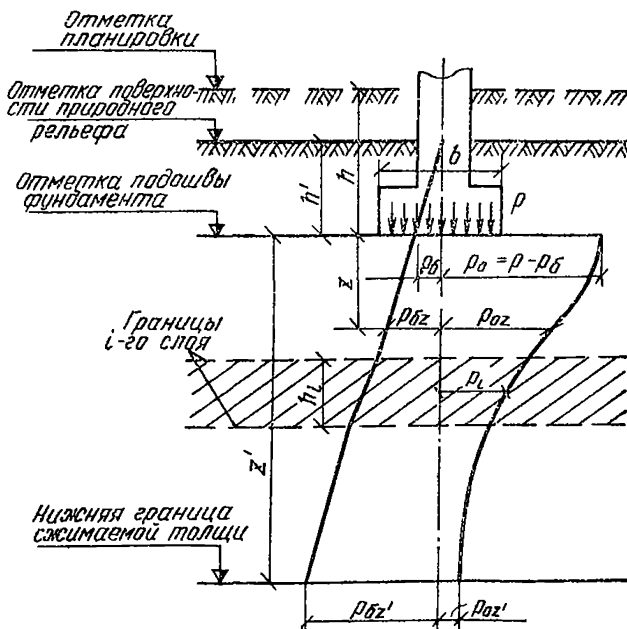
(прил. 3). Схема для расчета осадок методом послойного суммирования
